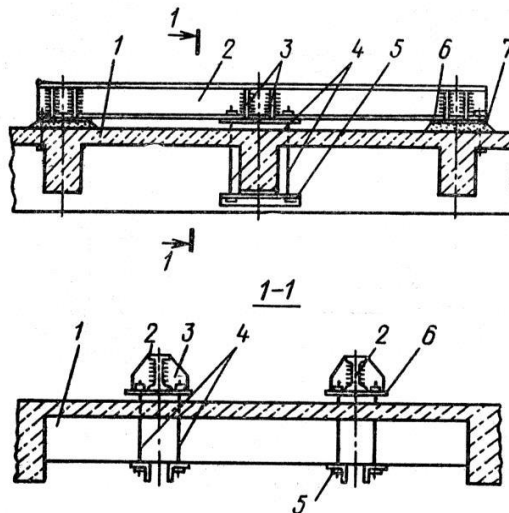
Усиление балки и плиты перекрытия металлическими балками сверху:
